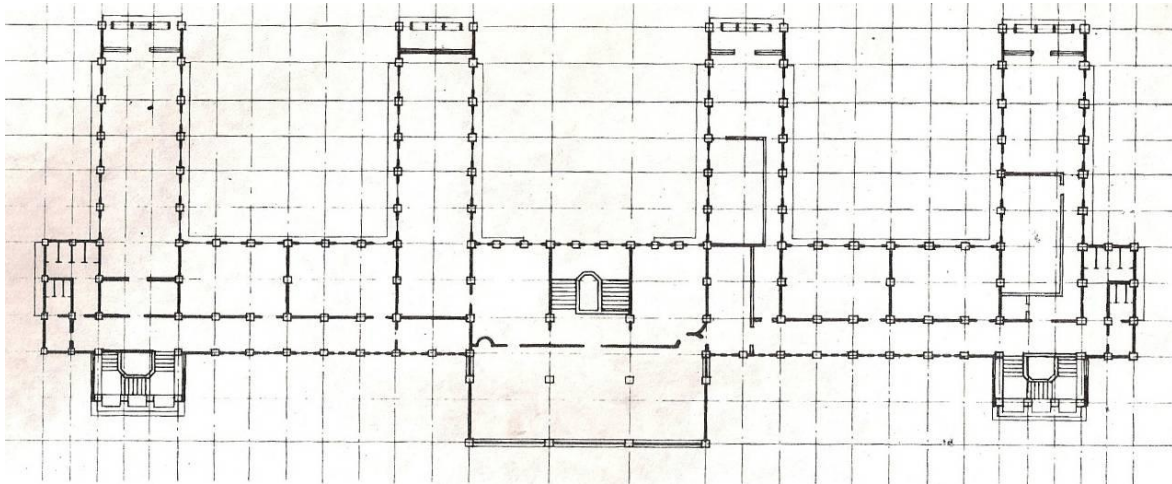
Grundriss des Erd- und Obergeschosses des Kammgebäudes der Fakultät für Ingenieurwesen.
